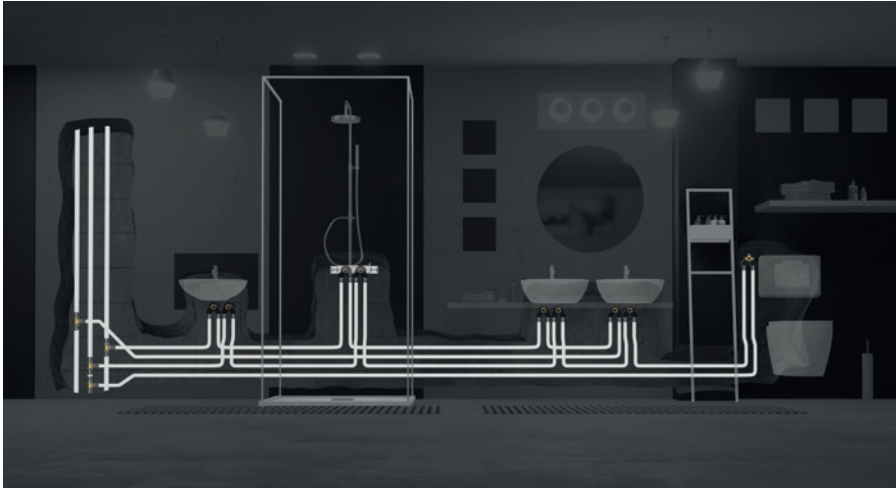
Conduites de circulation avec raccordement à la conduite de retour.
